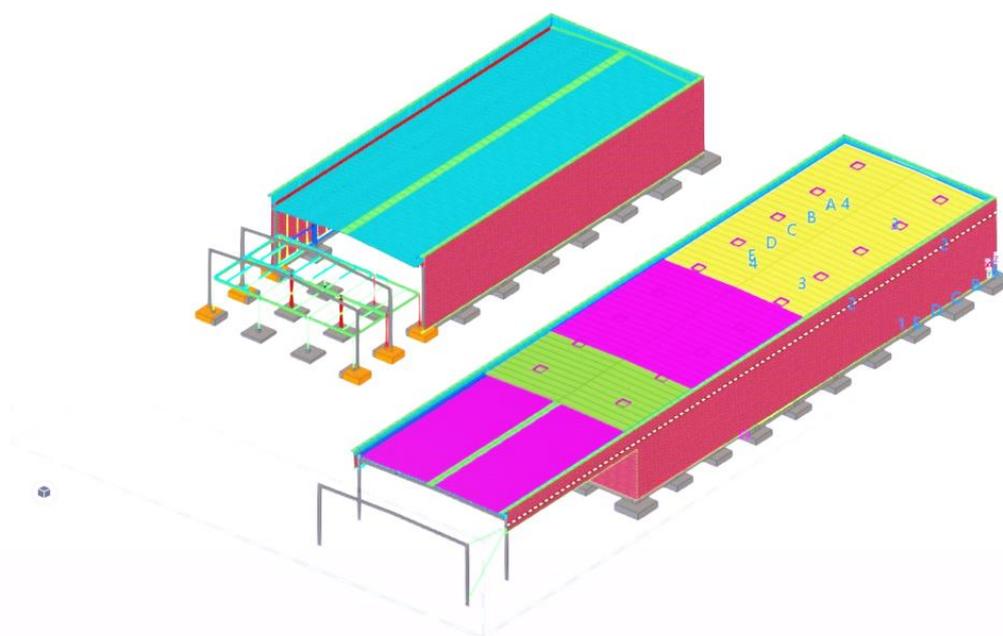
Planta estrutural 3D edifícios A e B (Acervo da DST)
